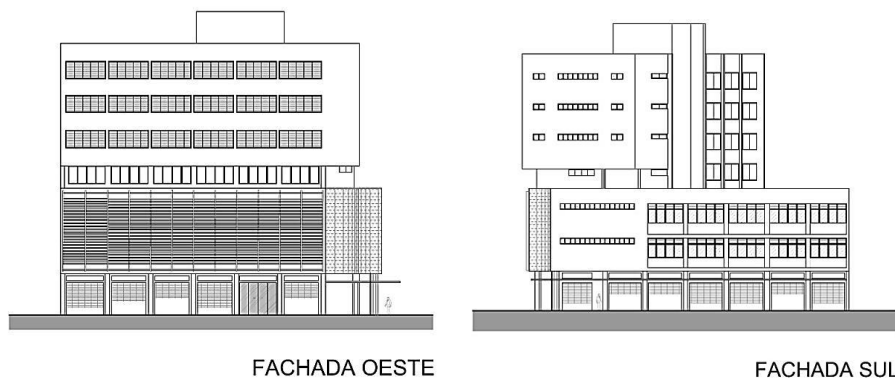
Fachada Oeste do Centro de Exportadores, retirada do projeto original.
